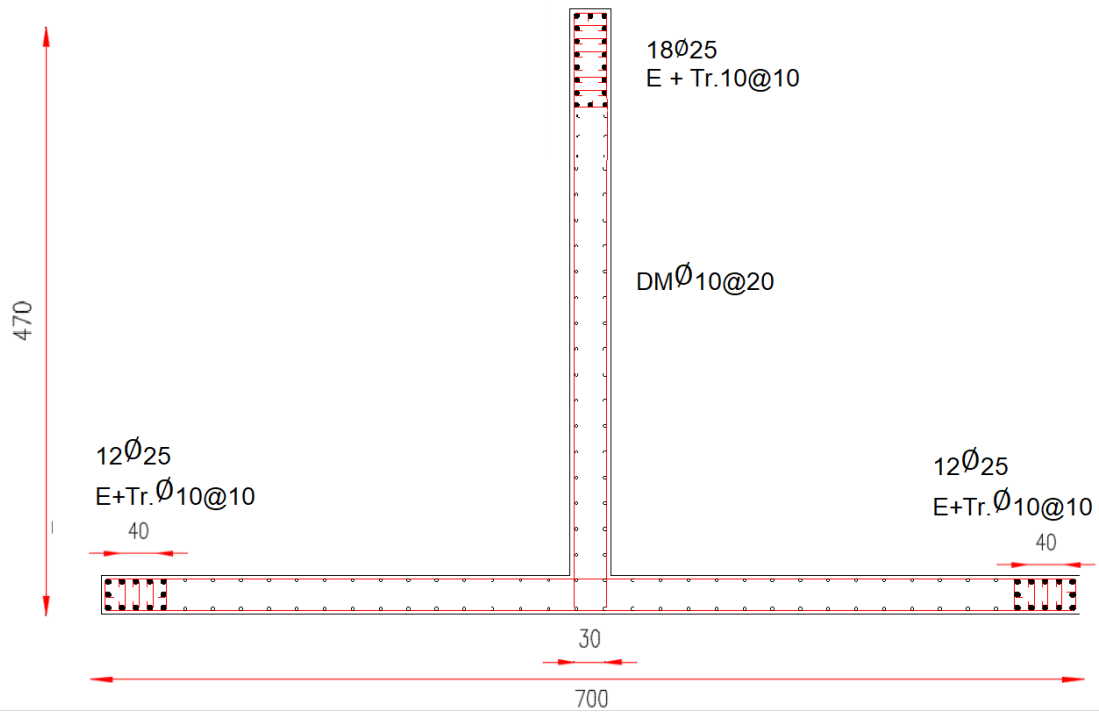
Disposición de armadura muro T modelo de 30 pisos.
